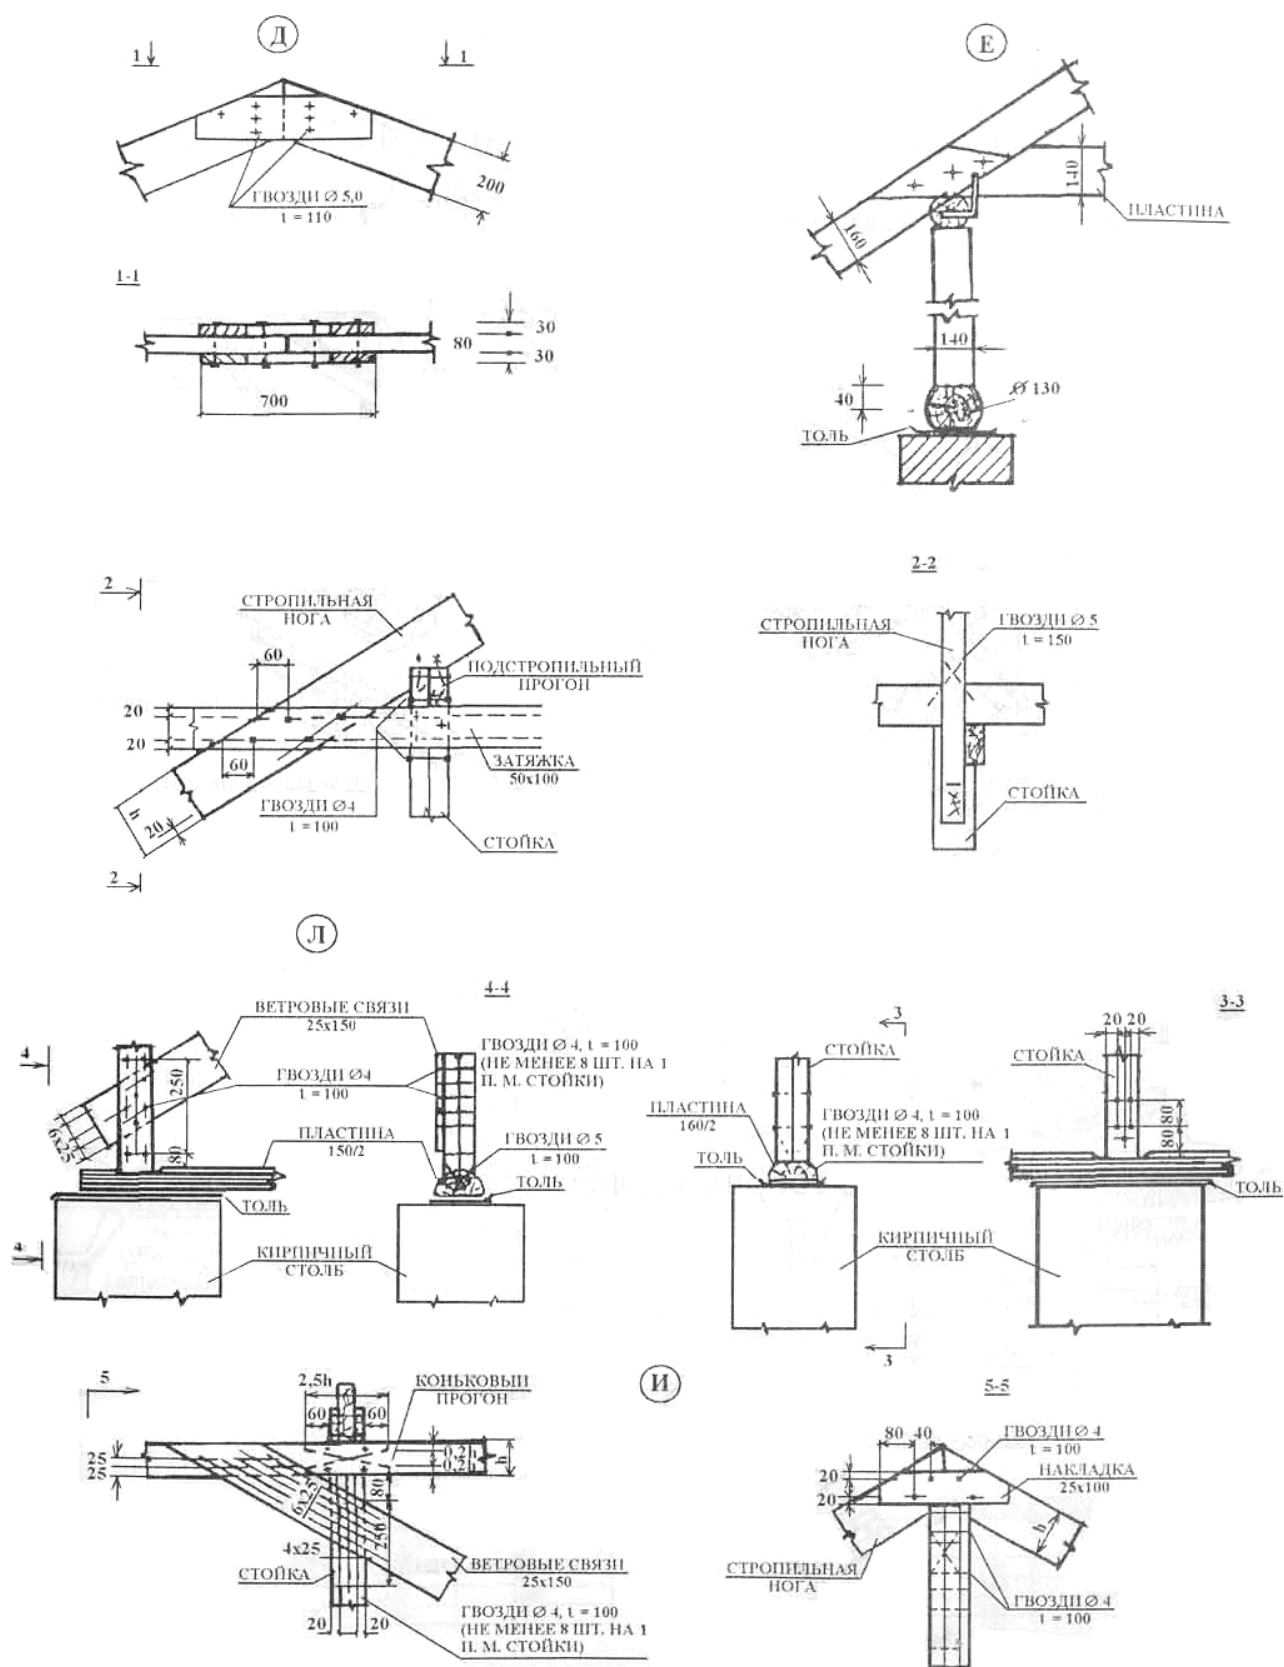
Узлы стропильных покрытий (продолжение)
